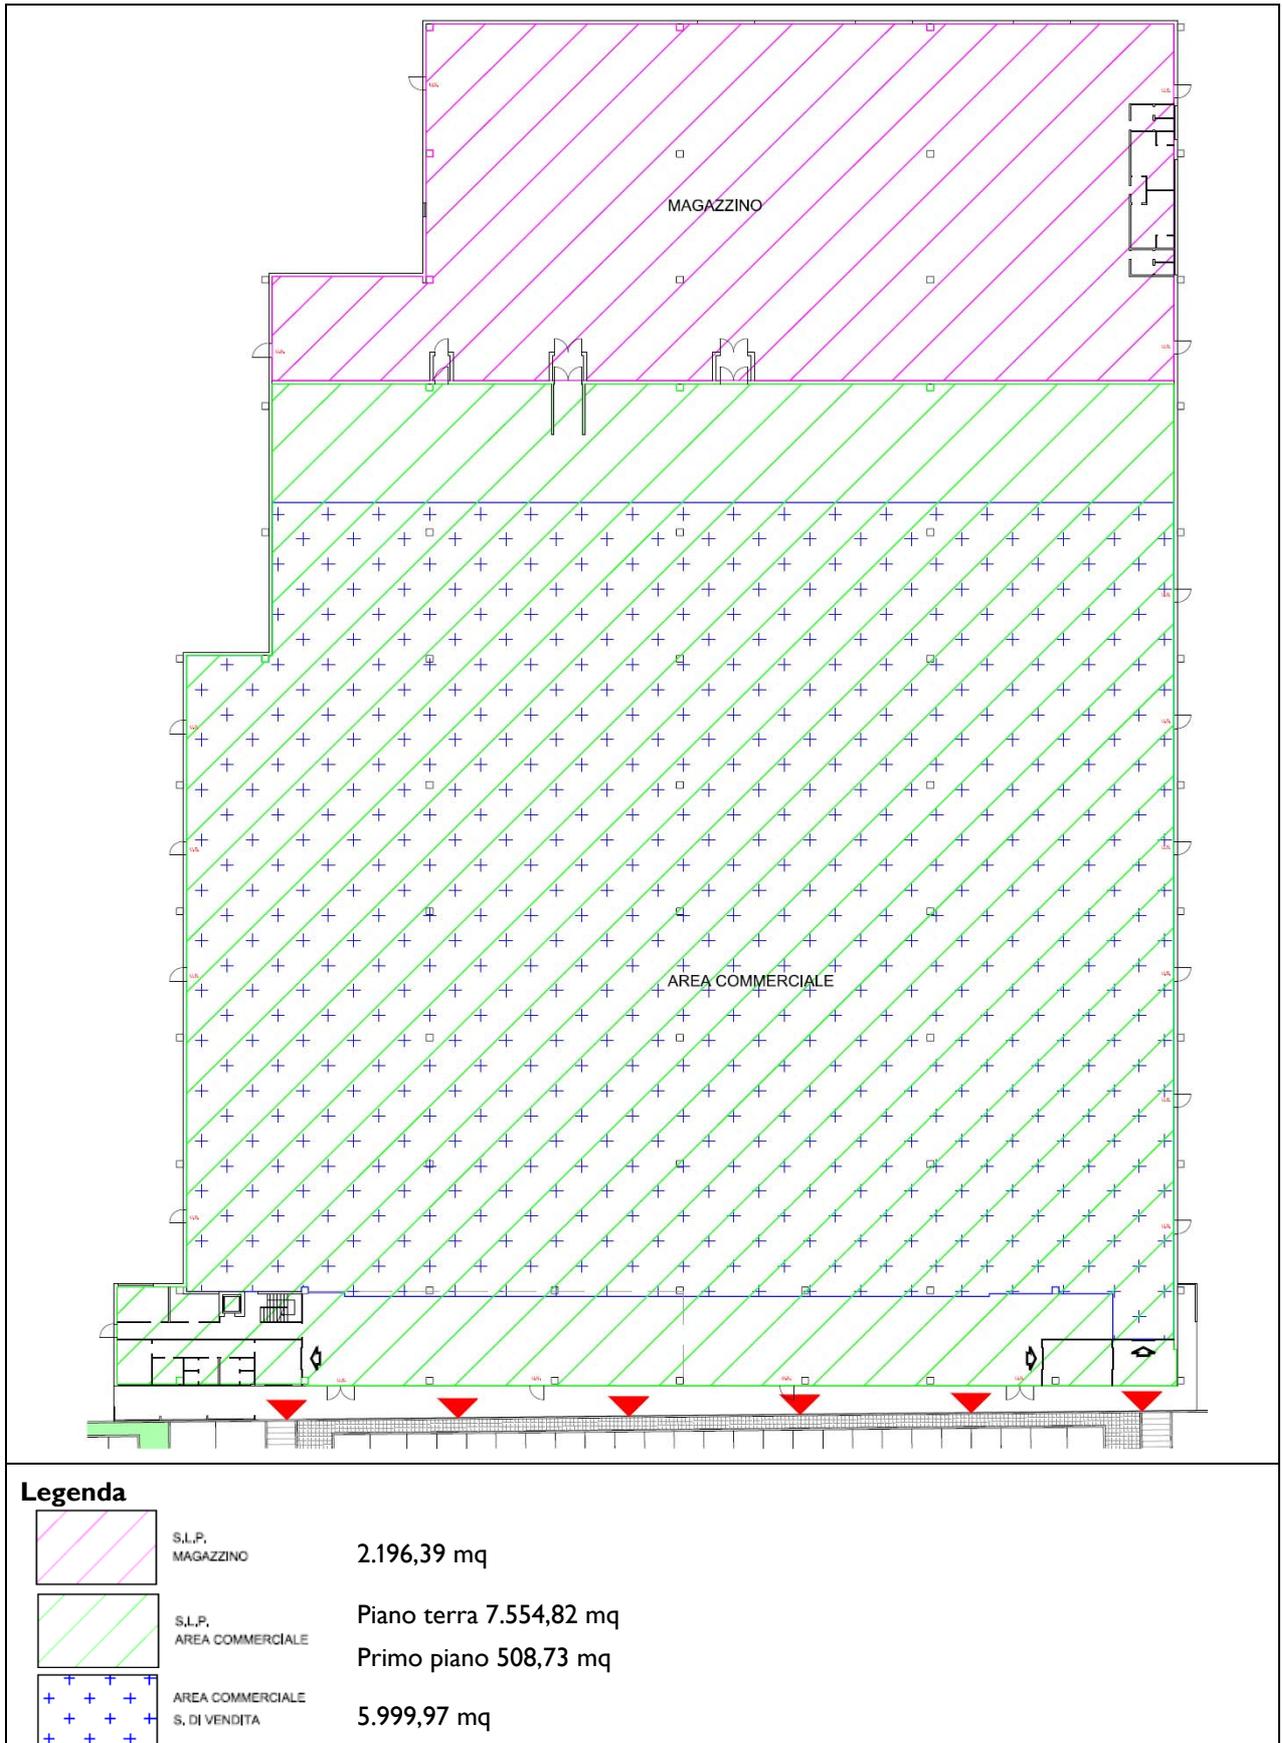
Planimetria dell'edificio ad uso commerciale, piano terra (estratto Tavola 06)
